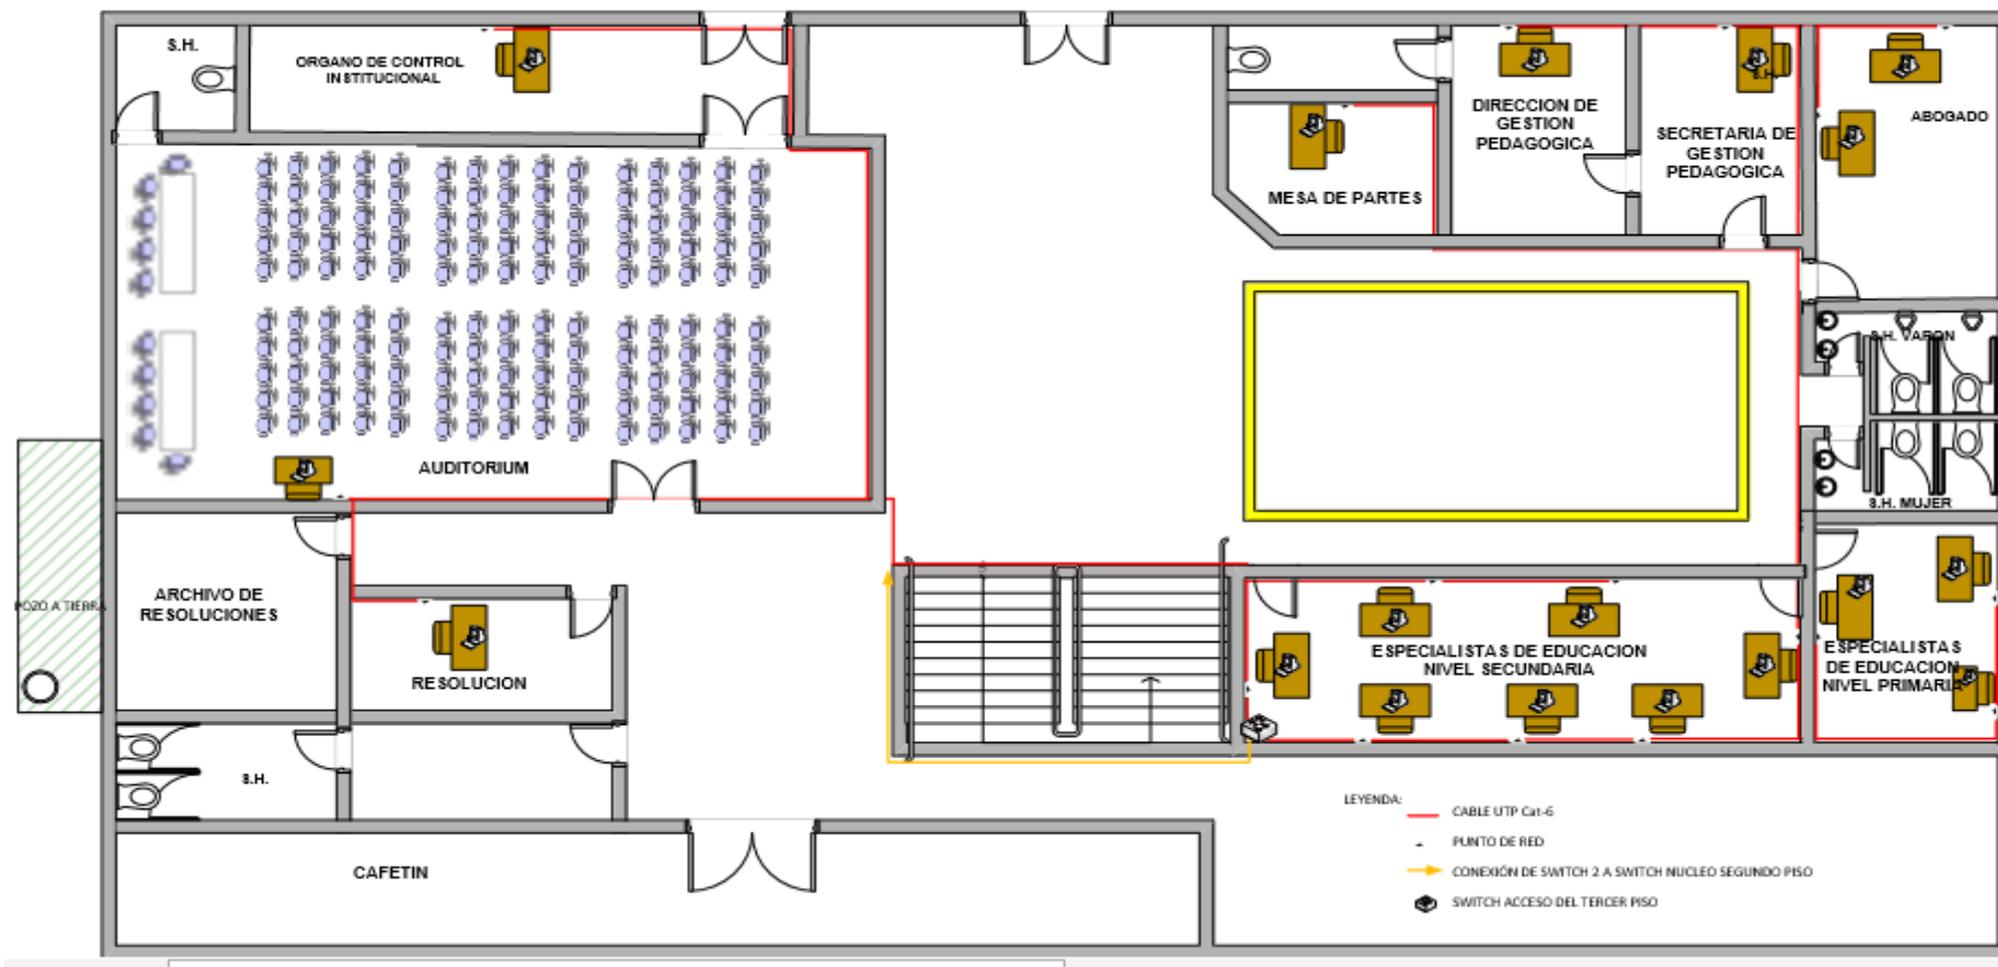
Plano de cableado estructurado del primer piso del edificio de la UGEL Acobamba
